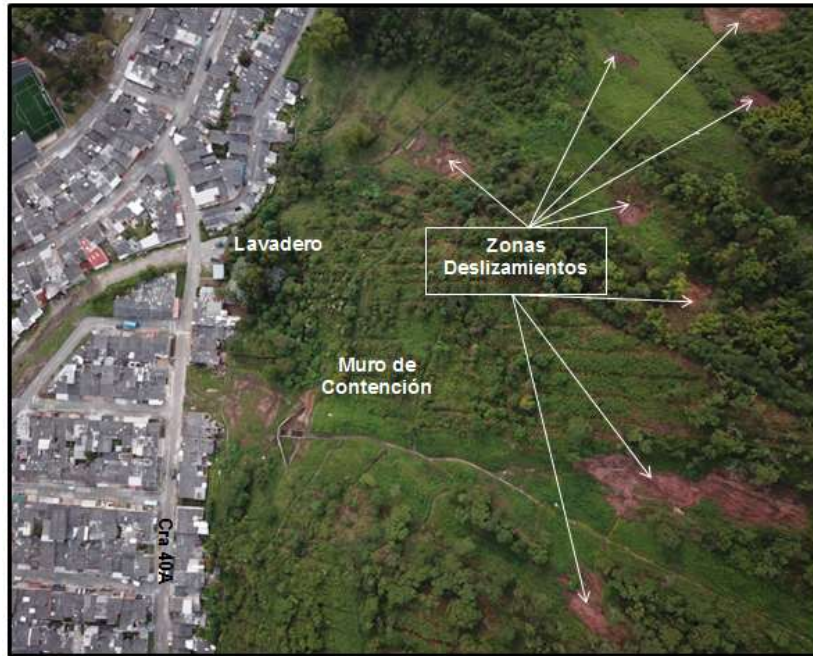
Fotografía aérea sector Aranjuez – Barrera de contención – Casas carrera 40 – Zonas deslizamientos talud superior – Levantamiento Fotogramétrico
